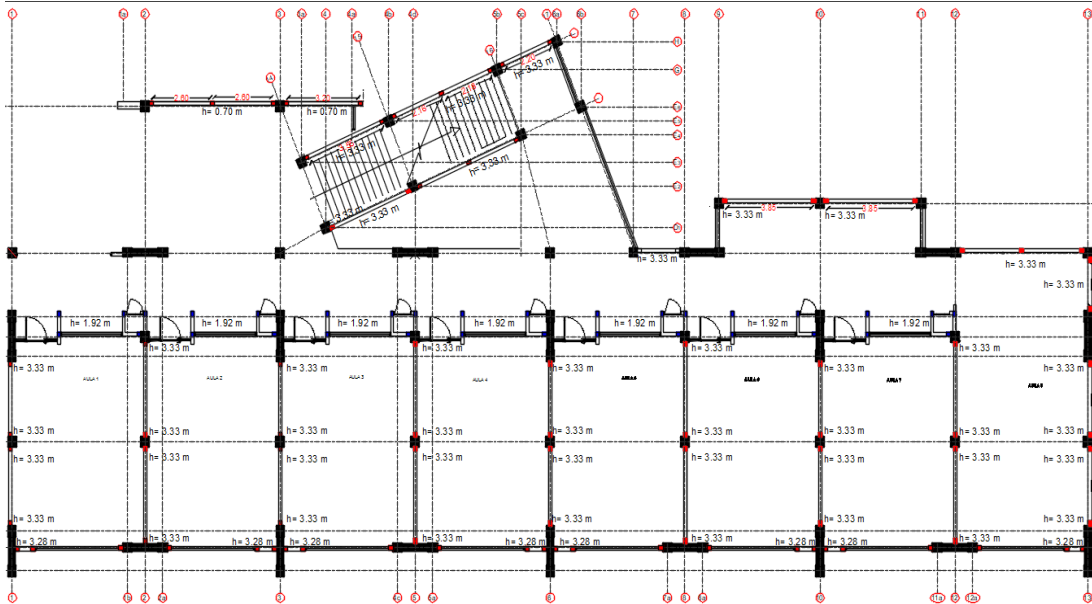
Columnetas planta de distribución 2 pisos – fuente propia
